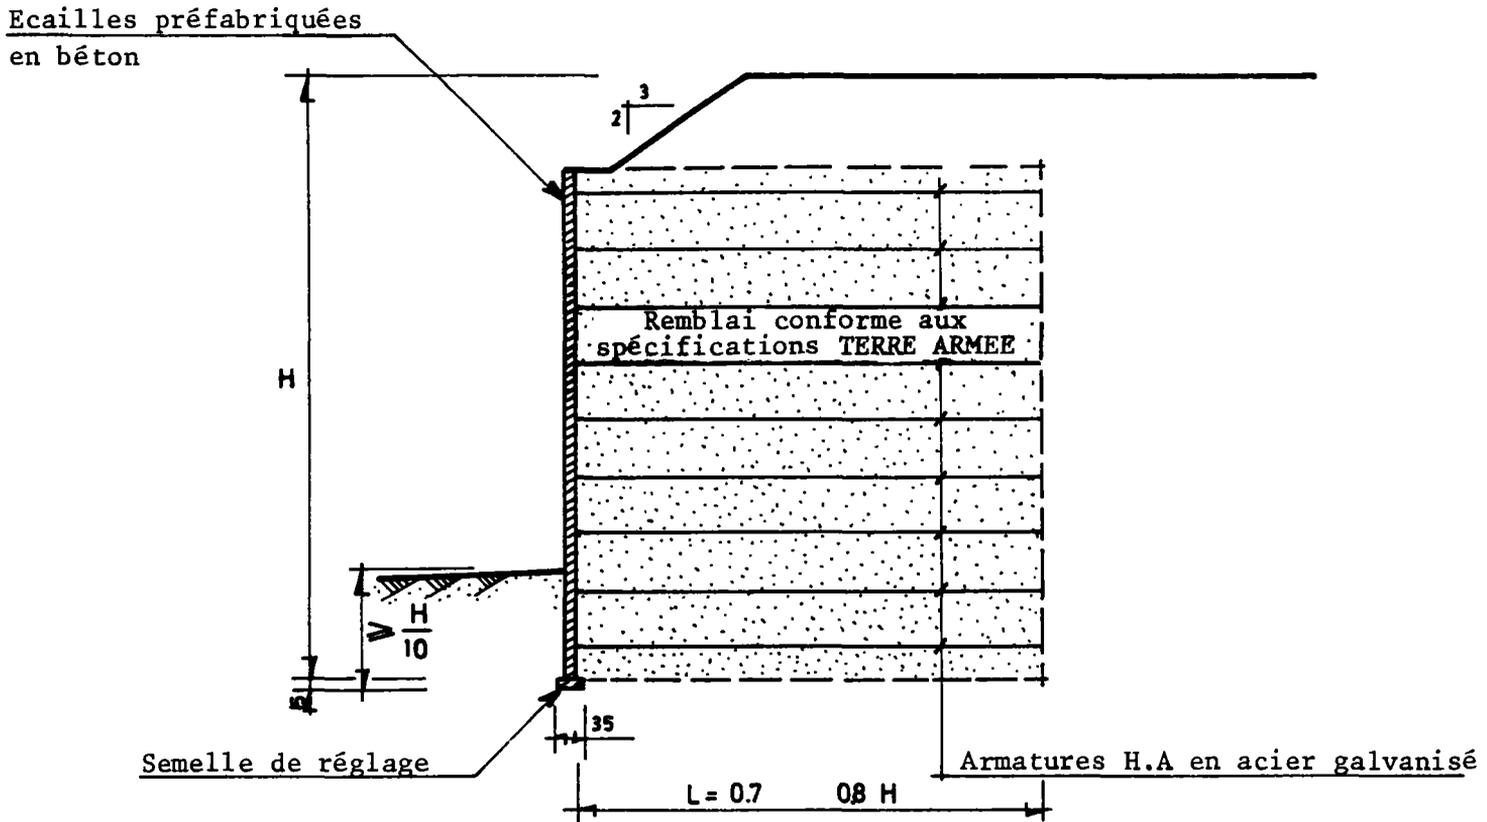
Dimensionnement d'un mur en terre armée
